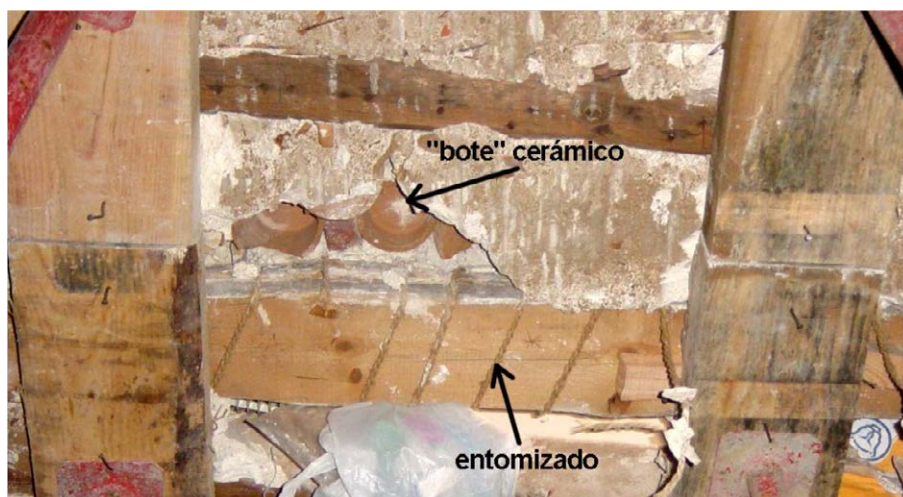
Vista inferior de un forjado aligerado con botes cerámicos (foto F. López)
